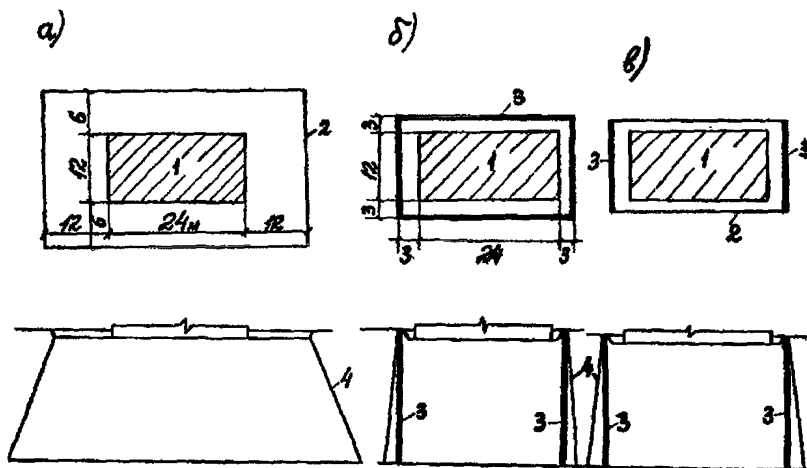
Схемы уплотнения просадочных грунтов предварительным замачиванием по обычной методике [1] (а); с устройством глубокой прорези по всему контуру котлована (б); по меньшим сторонам котлована (в); 1-здание; 2-контур котлована; 3-глубокие прорези; 4-боковая граница увлажненной зоны
